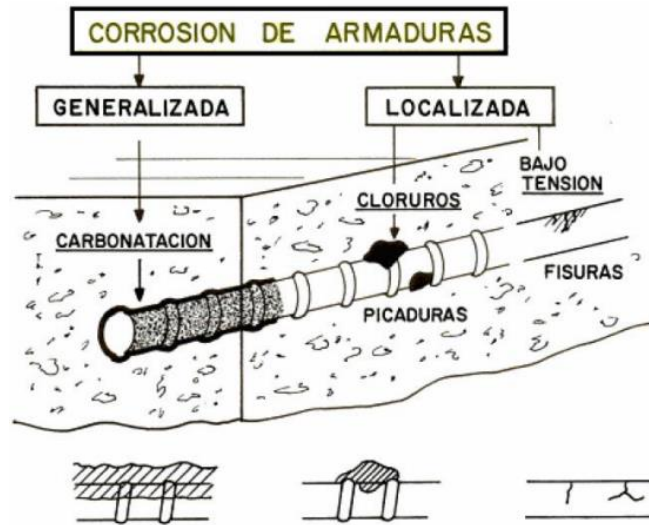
Tipos de corrosión en armaduras de concreto (Andrade, 1989).
